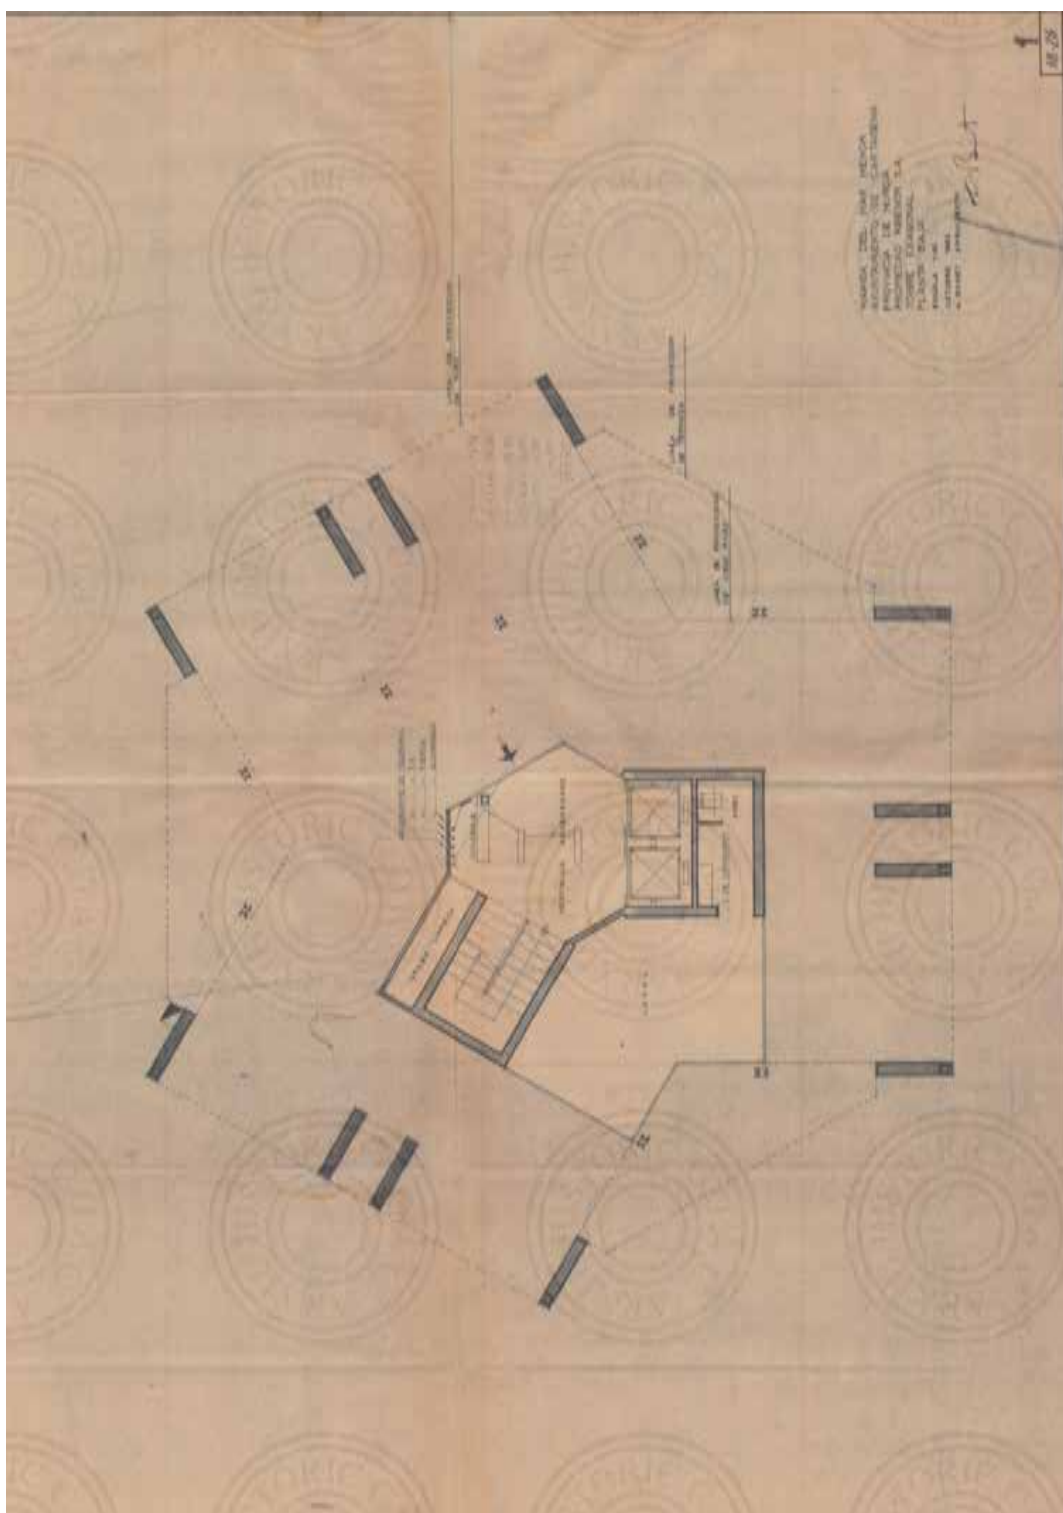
Planos del proyecto original de la Torre Hexagonal. Antonio Bonet Castellana. Plano de planta baja. Escala original 1/50. Fecha octubre de 1963. Fuente: Arxiu Historic COAC
